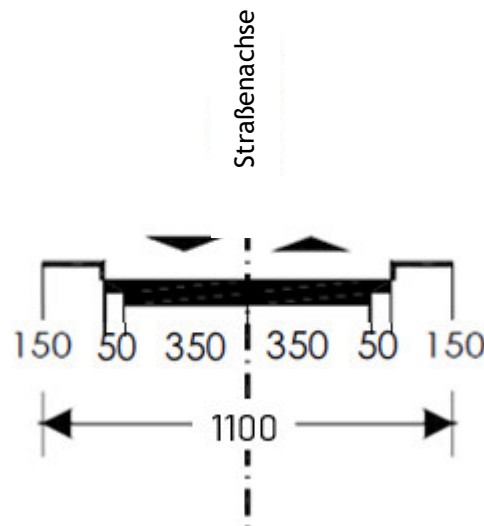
Typisches Querschnittsprofil einer Stadtviertelverbindungsstraße mit Busverkehr
